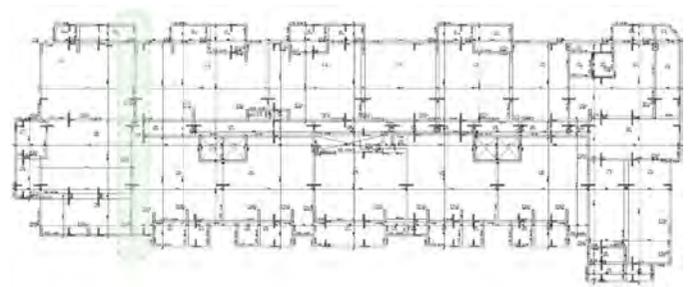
Pavimento tipo com destaque para o pórtico analisado
